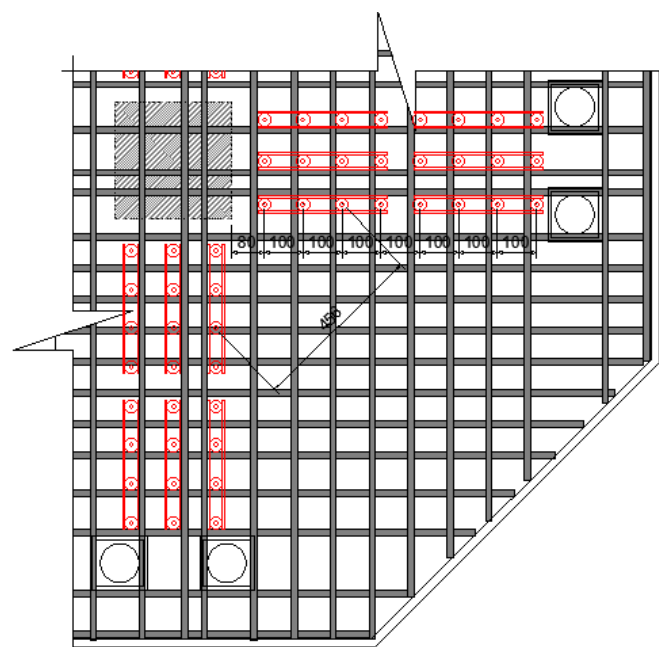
Disposição dos studs nas lajes (Autora, 2023).
